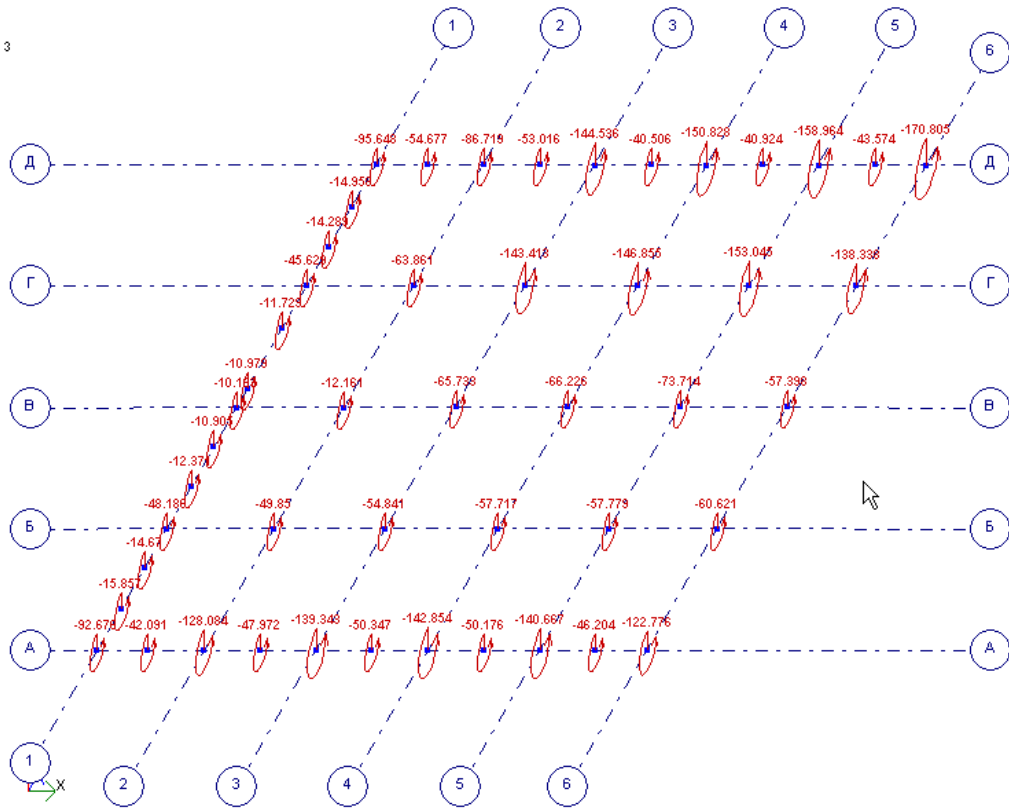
Навантаження на фундаменти (кНм) за наслідками РСН
